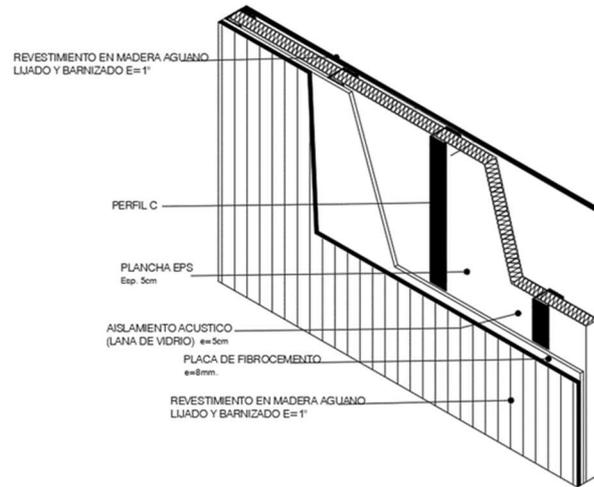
Detalle de Muro Tipo Sándwich.
